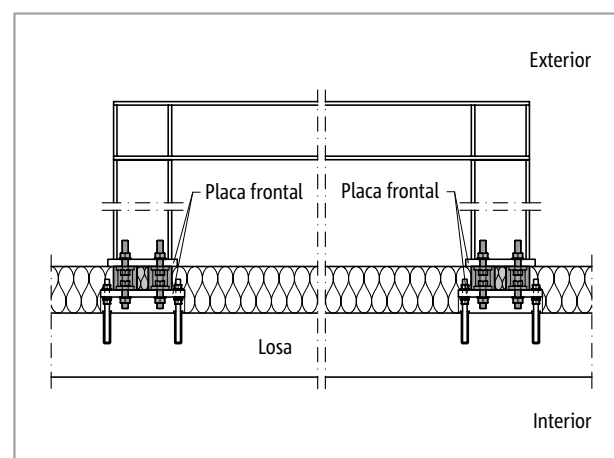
Schöck Isokorb® T tipo S-V: conexión de marco rígido para construcciones secundarias (se deberán tener en cuenta momentos adicionales por imperfecciones)
